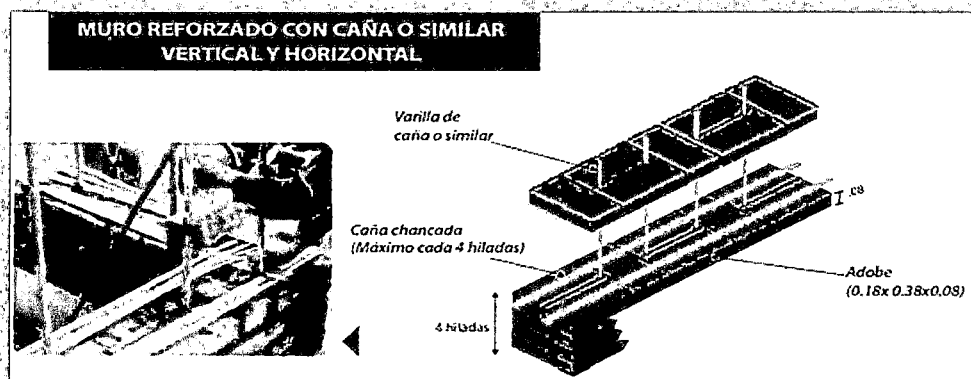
Muro reforzado con caña o similar vertical y horizontal.
